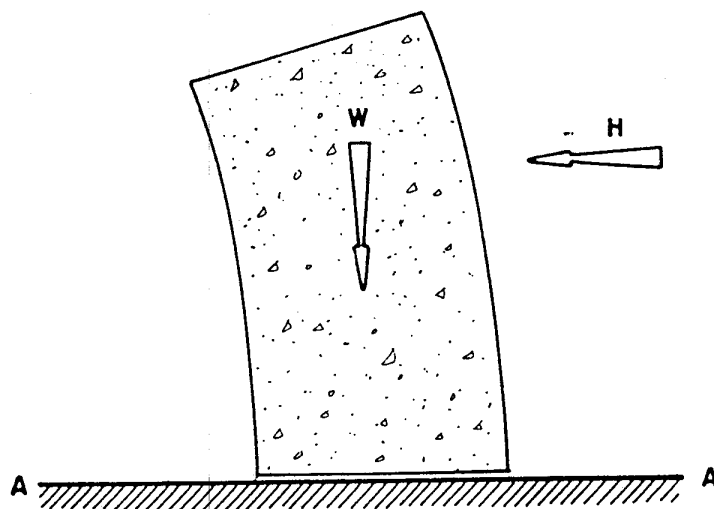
SOLICITACIONES SOBRE UN MURO ESTRUCTURAL.
